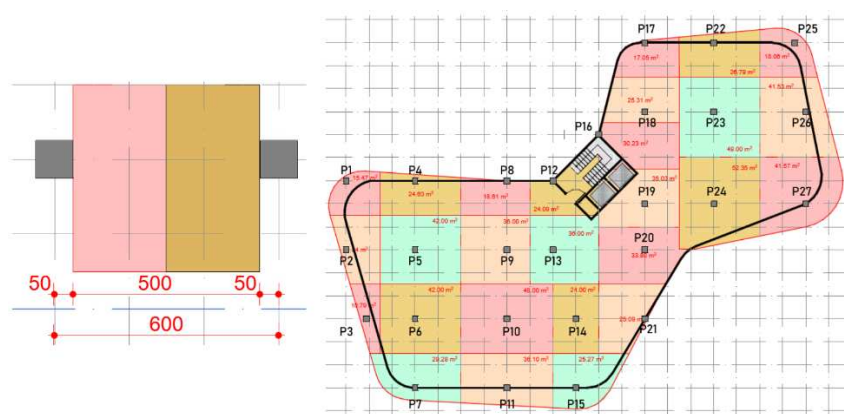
Módulo estrutural e lançamento de pilares. (a) Três módulos acomodando duas vagas (b) Pavimento Tipo, pilares e áreas de influência. Fonte: Autora, 2025.
